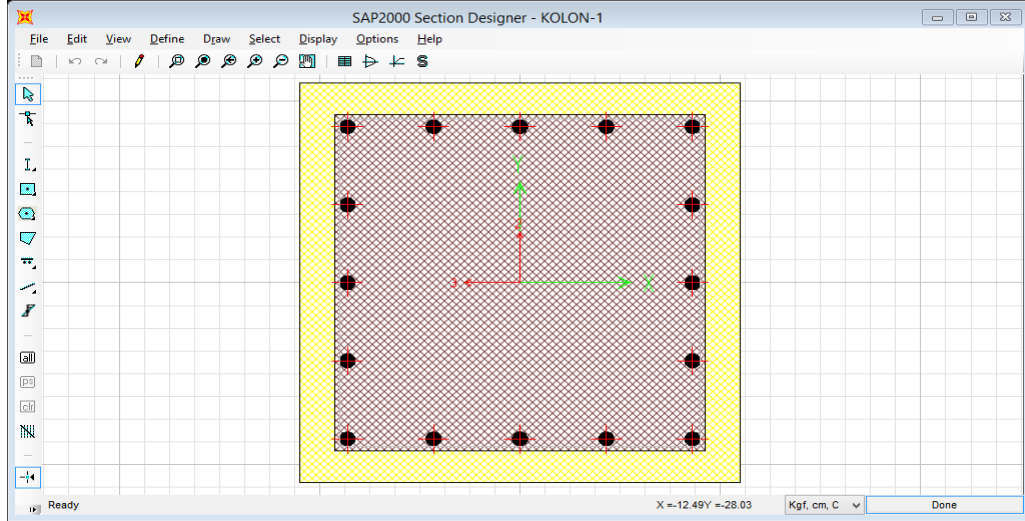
Kolon etriye donatılarının tanımlanması
